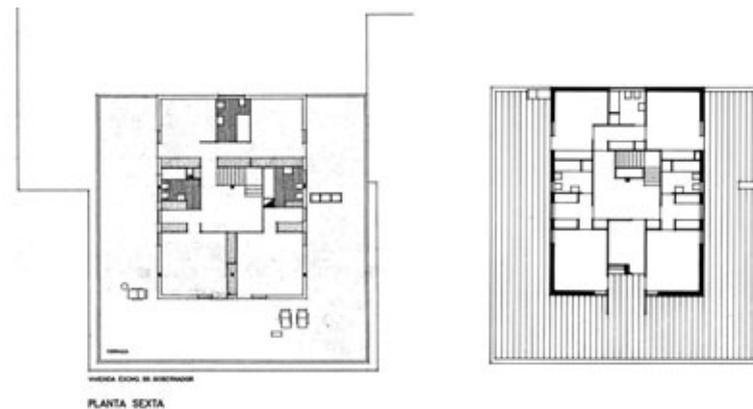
Plano del anteproyecto del concurso y plano reformado de la planta sexta. Fundación Alejandro de la Sota.
